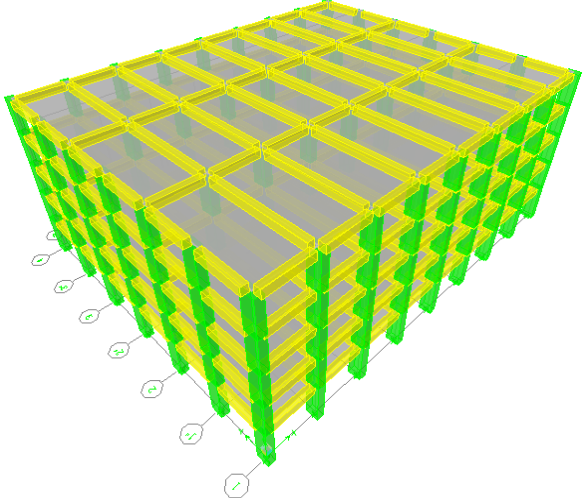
Vista en planta edificio con NSR 98. Fuente: El autor (a)
